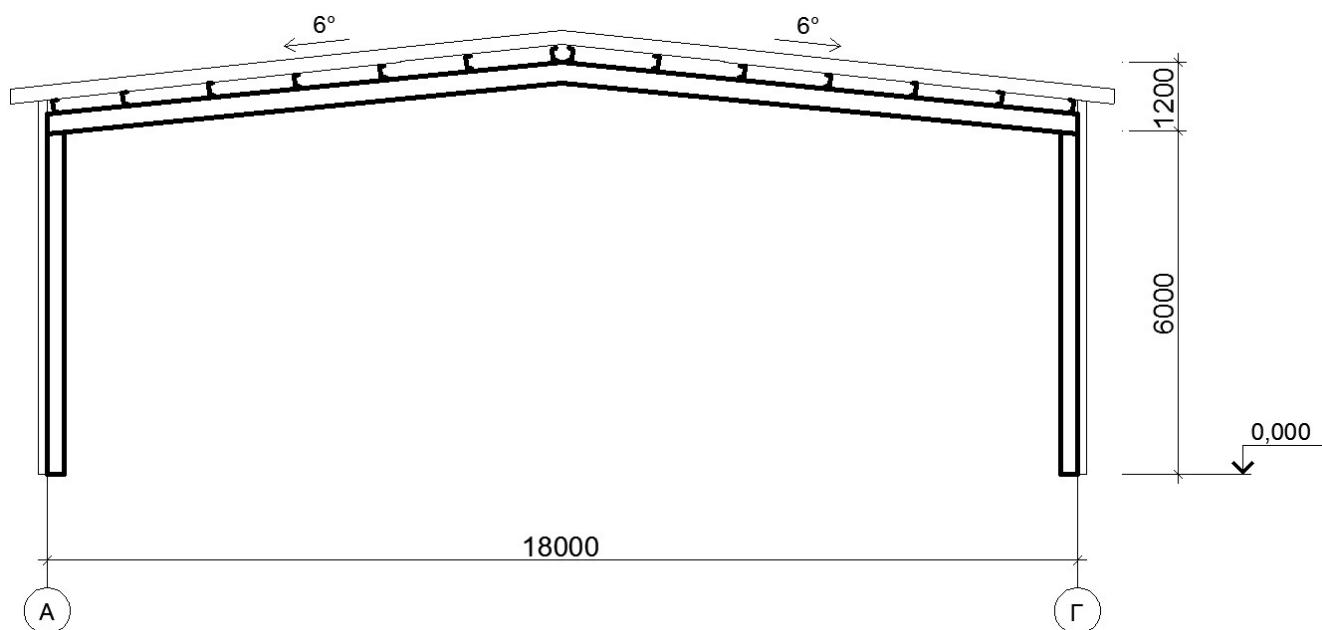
Компоновочная схема поперечной рамы здания
